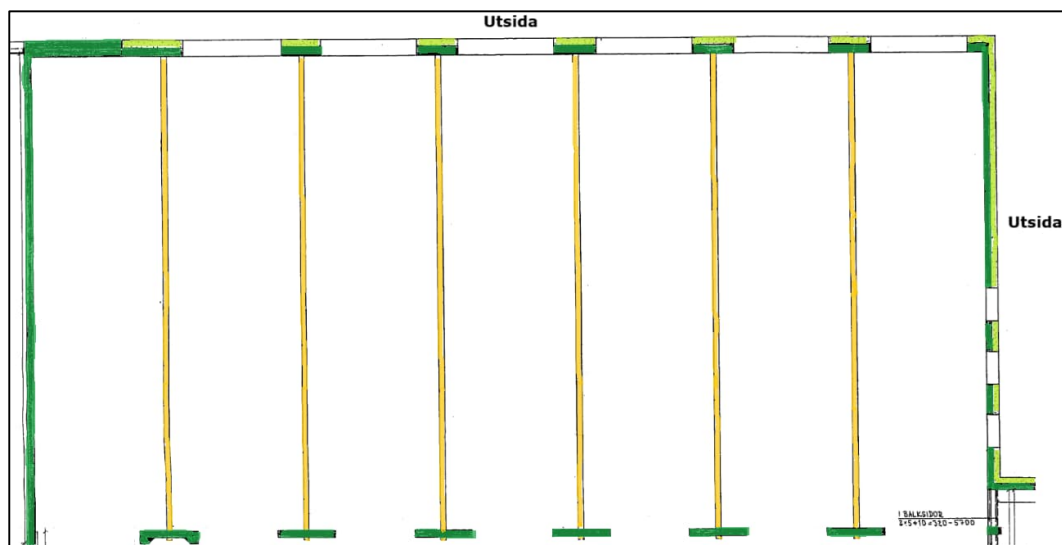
Väggarna i plan 1 består av platsgjuten betong (grön) och lättbetong (ljusgrön), (från ritn K31:061-1, Husdel 06, Plan 1, Väggar, AR 1977-10-17).
